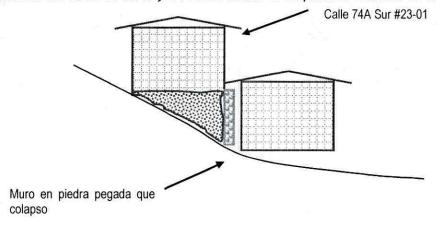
Detalle de localización del muro que colapso en la vivienda de la Calle 74A Sur # 23-01
